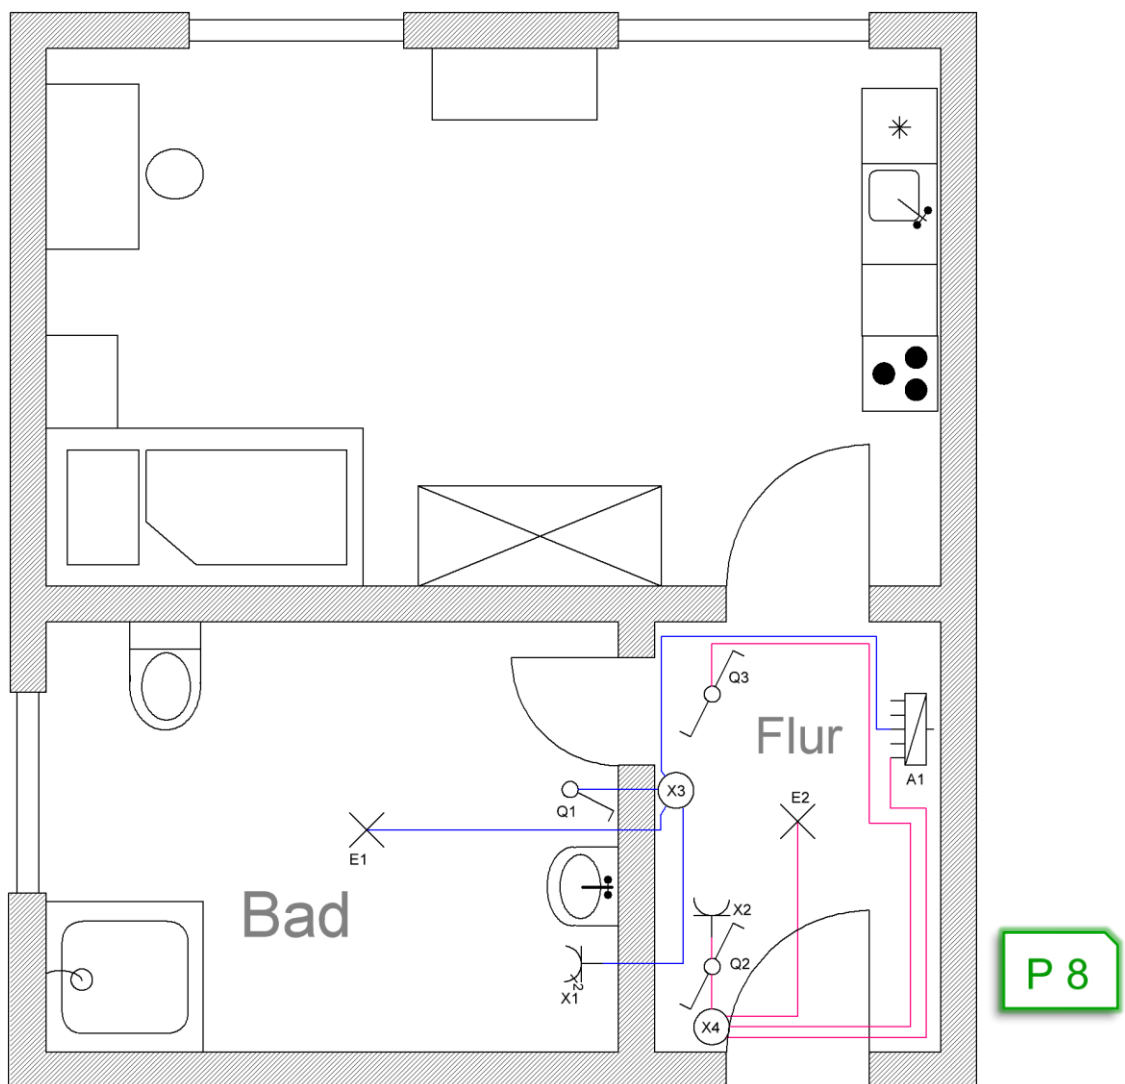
Installationsschaltplan der Wohnung von Klaus
